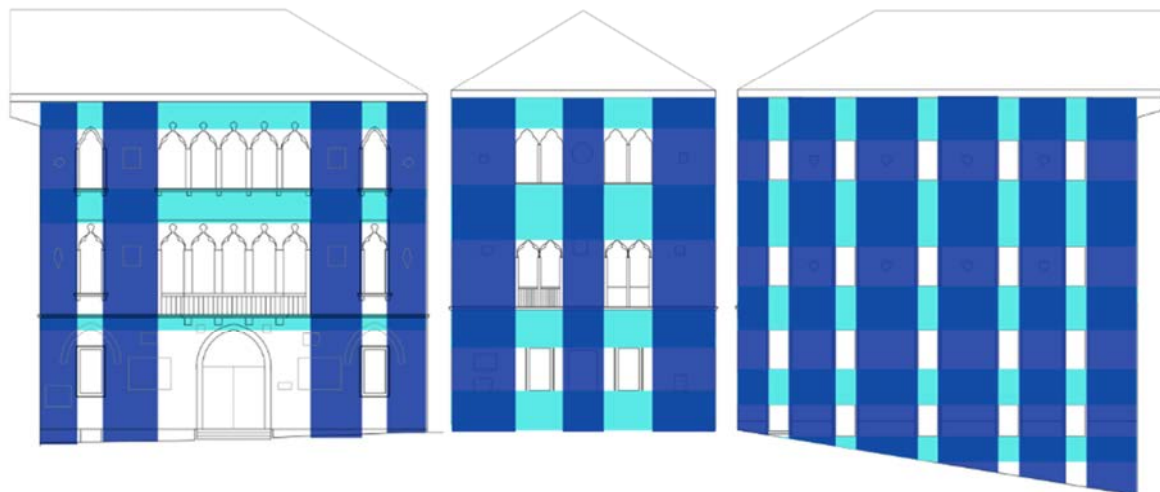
Schematizzazione della disposizione dei maschi murari (in blu) e delle fasce di piano (in azzurro).
